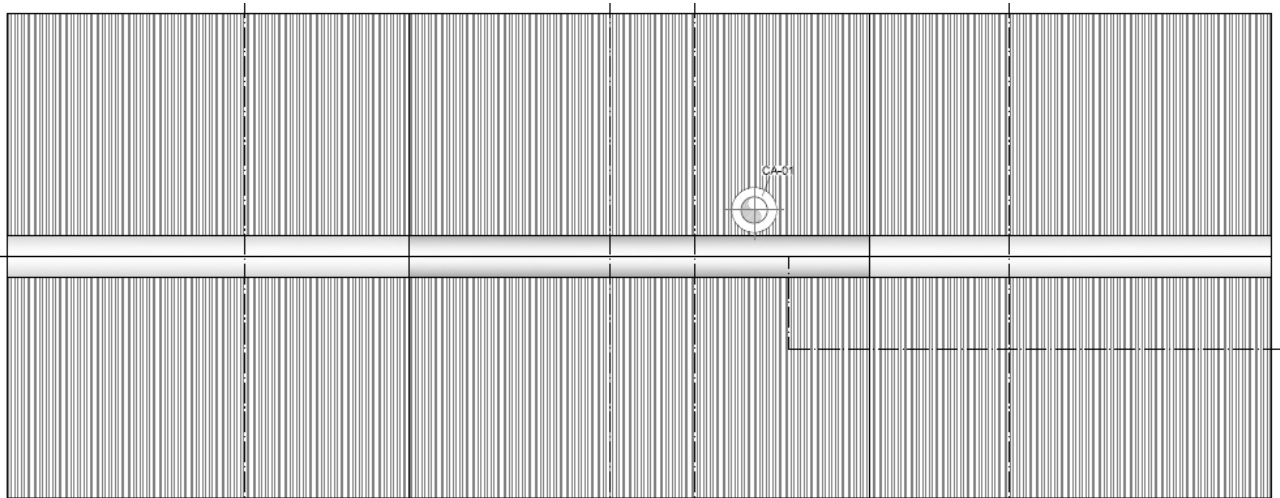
Pianta della copertura dell'impianto SVE di progetto
